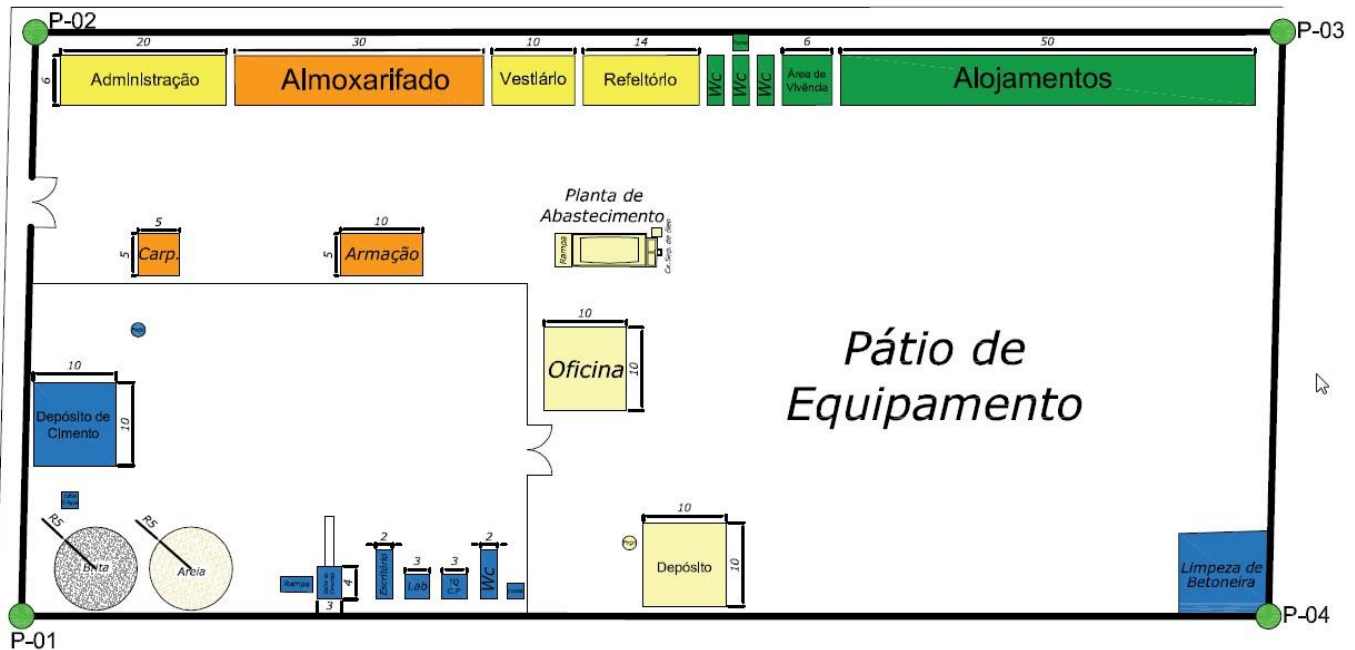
Esquema Ilustrativo das estruturas do canteiro típico de obras de LT.
